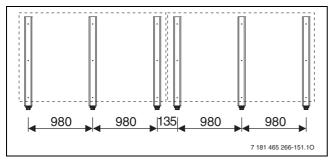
Grundausführung für 2 waagerechte Kollektoren
